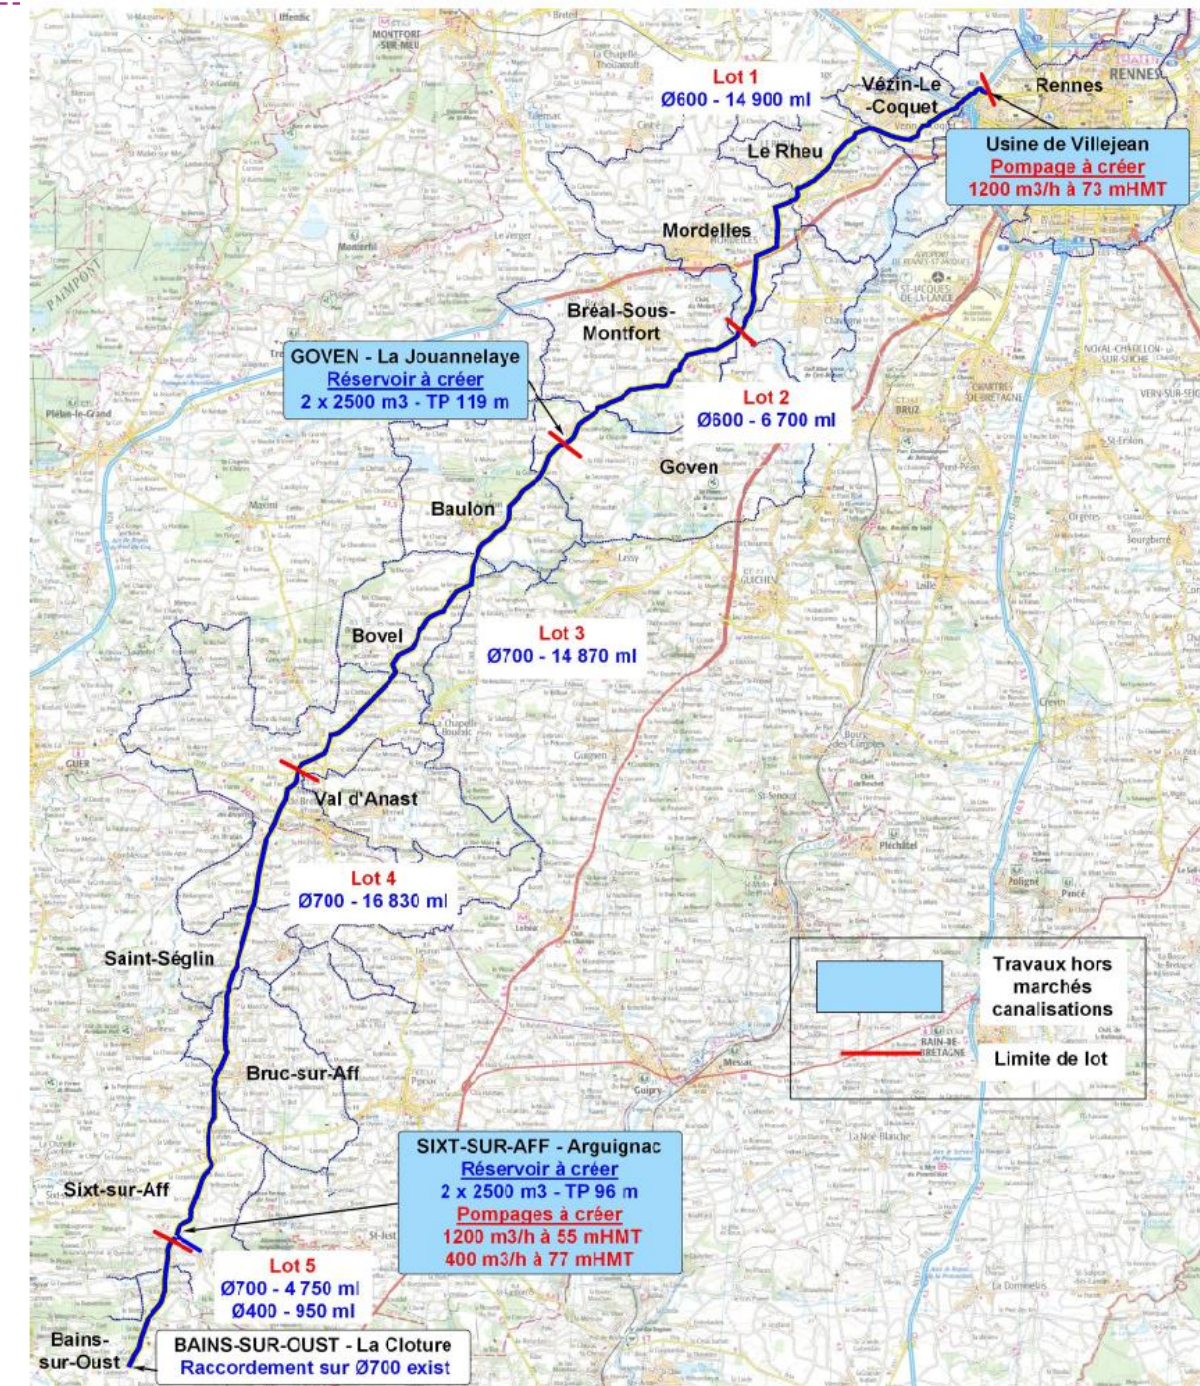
Plan général du tracé entre Bains-sur-Oust et Rennes
